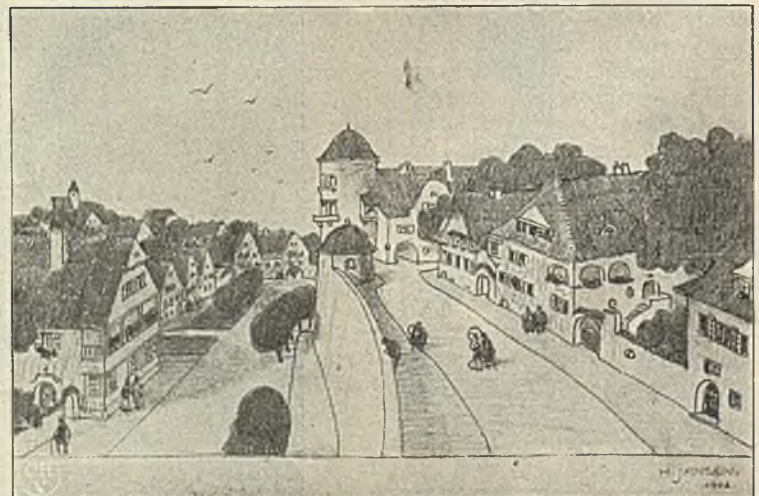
Aus Hermann Jansens Bebauungsplan für Frohnau, Wallstraße
